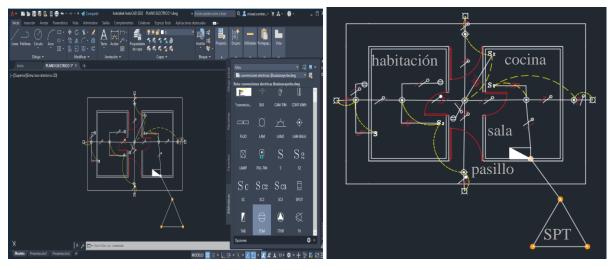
Plano de distribución del cableado eléctrico. (Autor)
